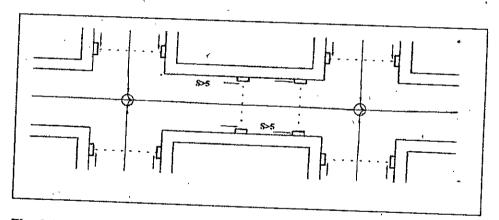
Ubicación de Coladeras Longitudinales de Banqueta.
